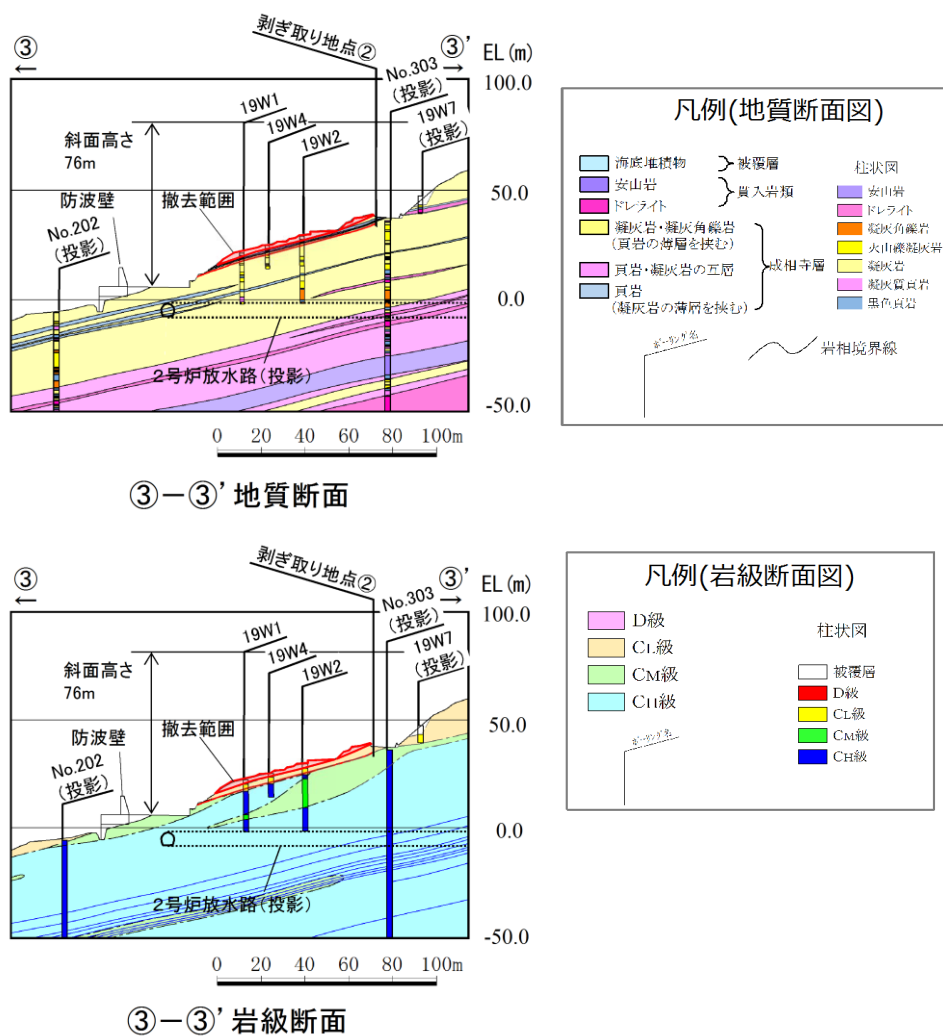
防波壁(西端部) 地質断面図・岩級断面図
